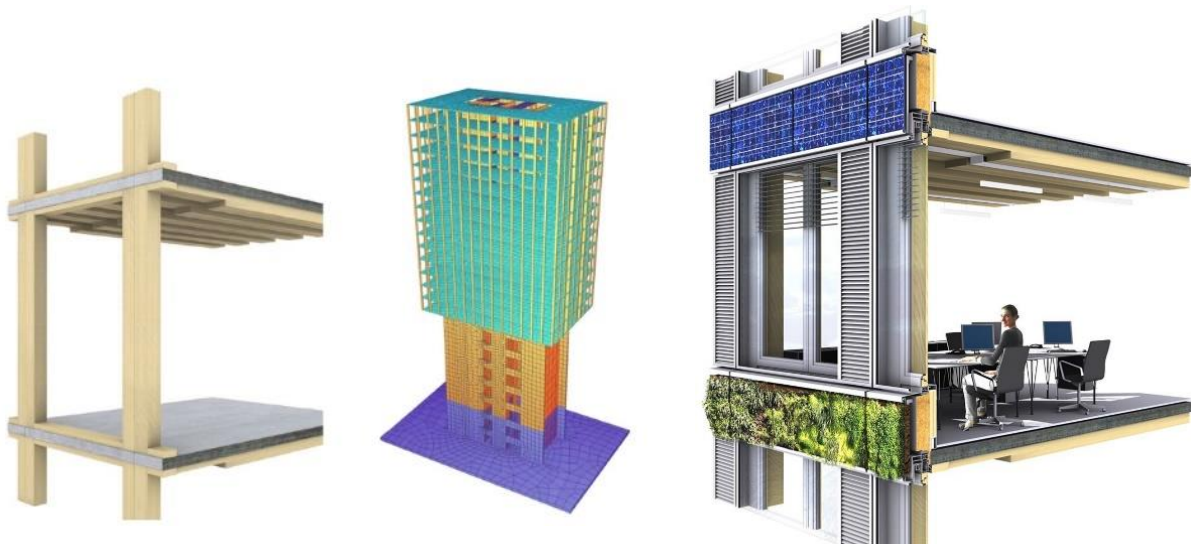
Konstruktion und Tragwerk im Holz-Beton Verbundbau sowie Fassadengestaltung von Wohnbau LCT ONE [74]
